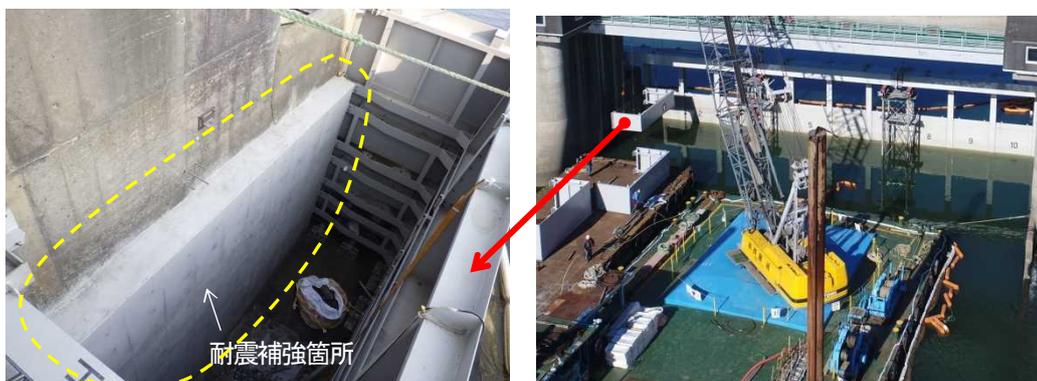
鋼製函体による仮締切内部状況と設置作業状況
